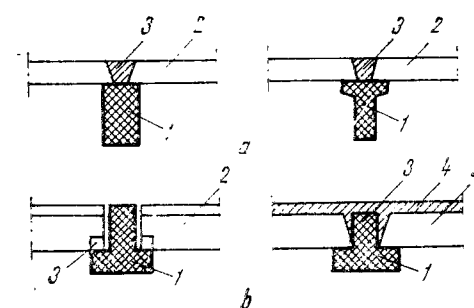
Rezemarea planșeelor pe riglele prefabricate ale cadrelor:
